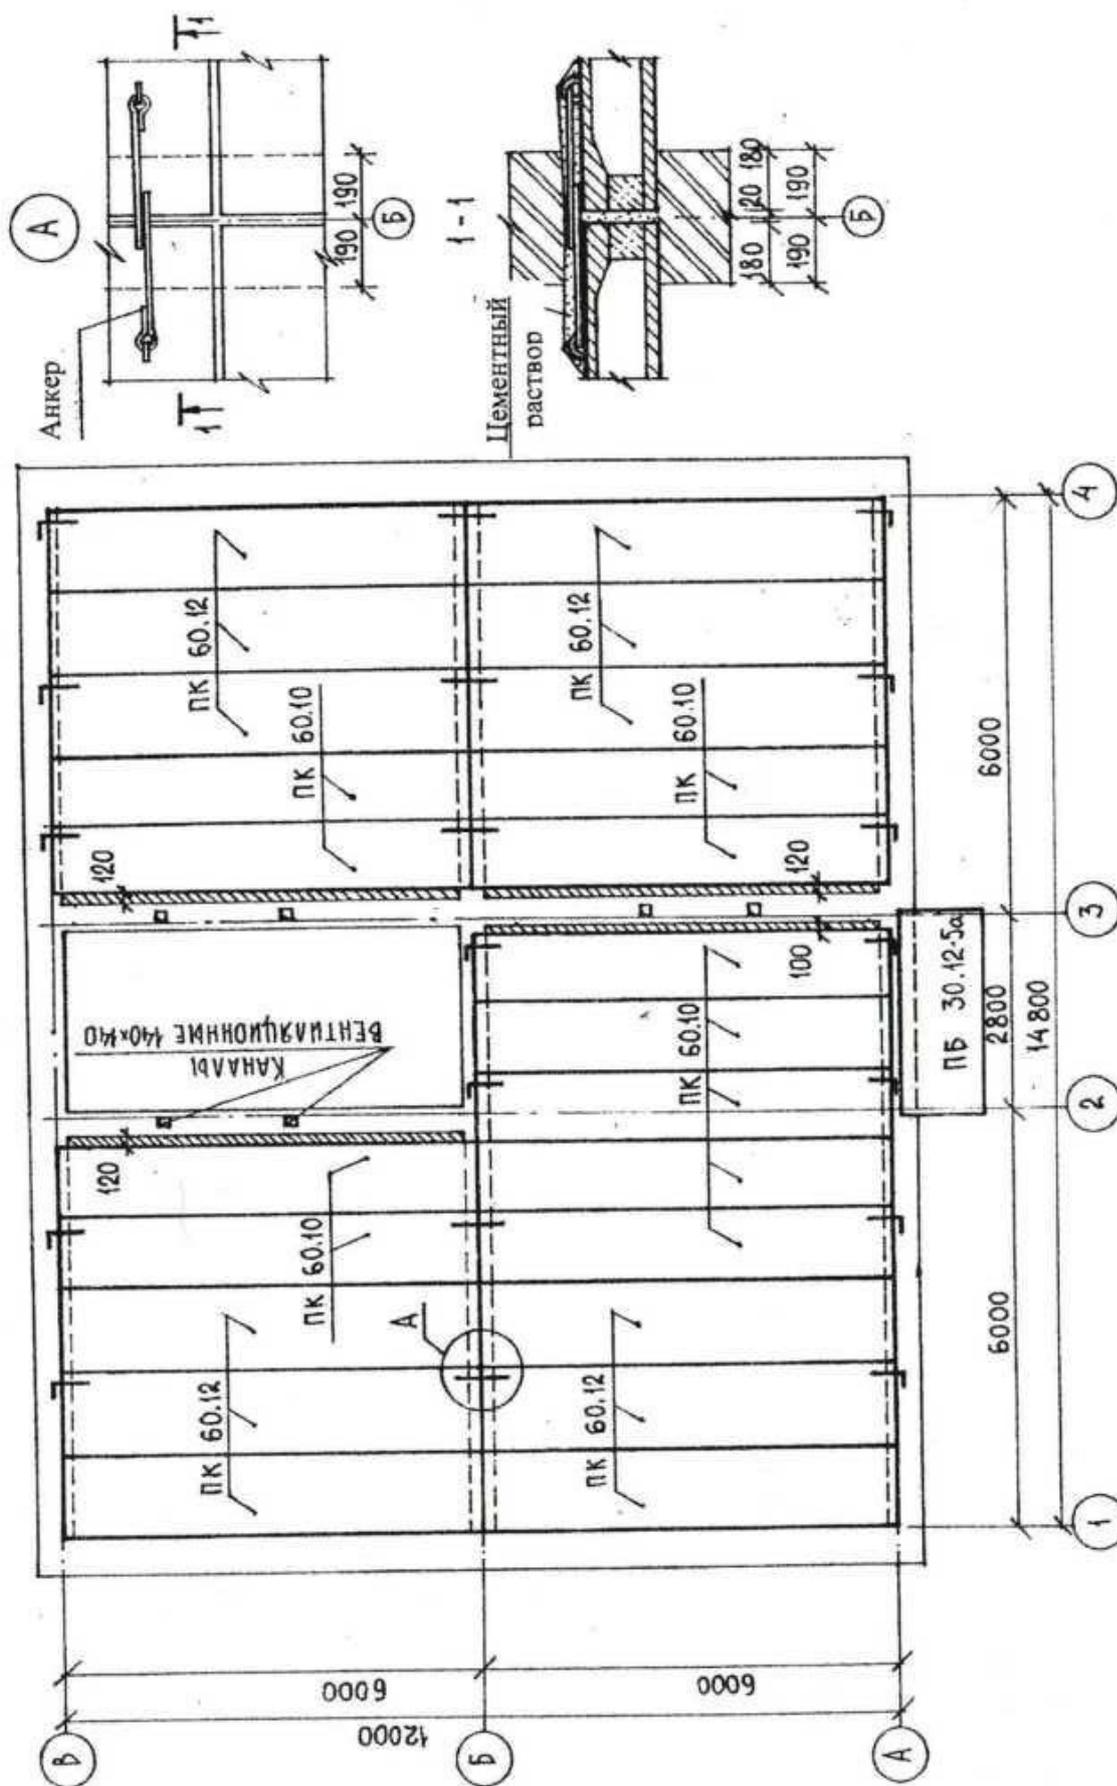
Схема расположения плит перекрытия на отметке +2,800
